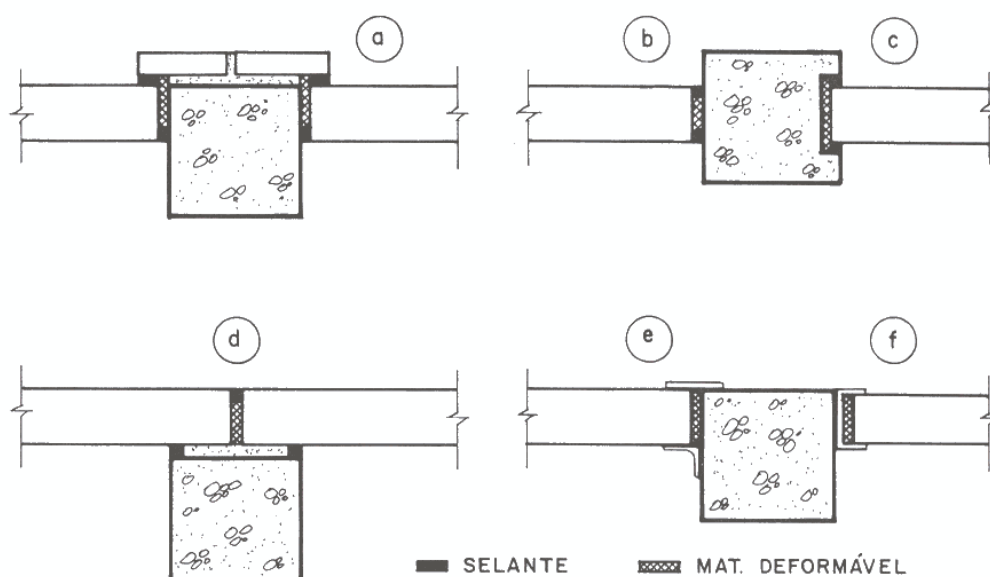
Juntas de acomodação entre alvenarias e pilares. (a) pilar revestido com tijolos cerâmicos; (b) junta aparente na borda do pilar; (c) junta não aparente, parede encaixada no pilar; (d) junta aparente no corpo da parede; (e) mata-juntas fixados aos pilares; (f) perfil de alumínio fixado ao pilar.
